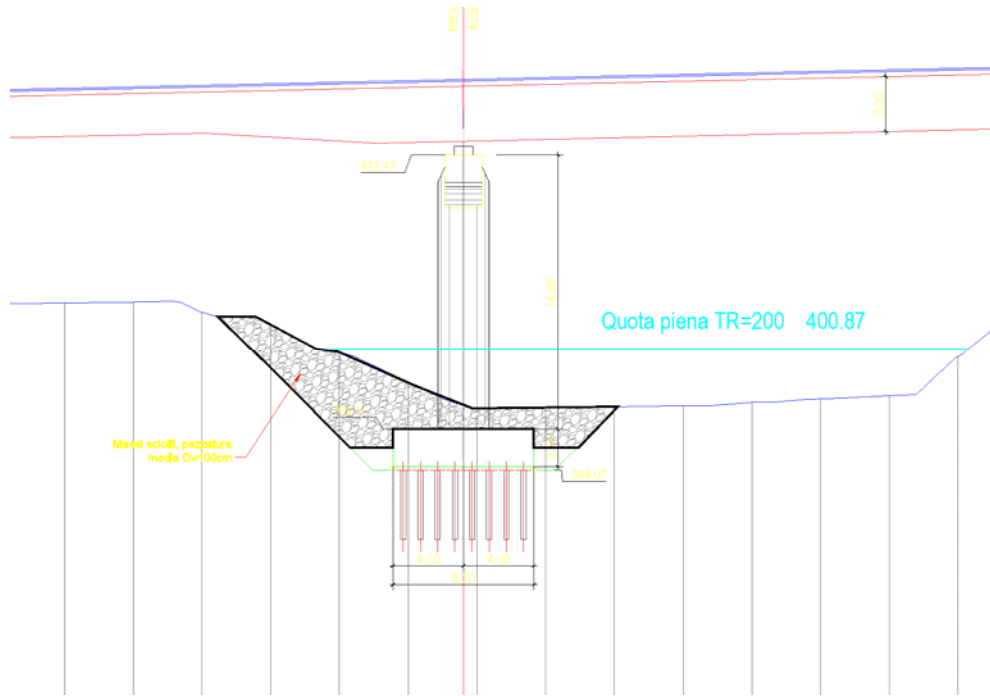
Viadotto Molino protezione pila P5 viadotto Sud
